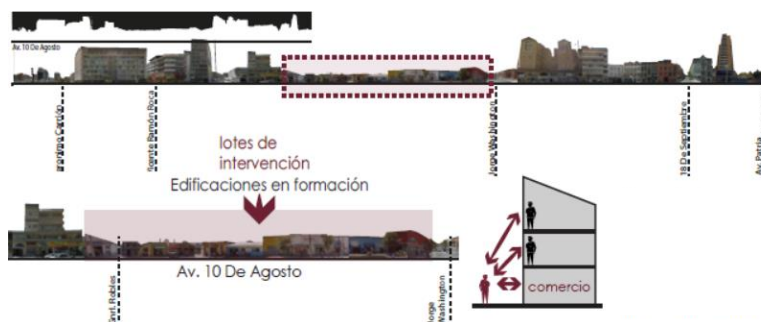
Borde a intervenir fachadas (Jordan Baldassari, 2018)
